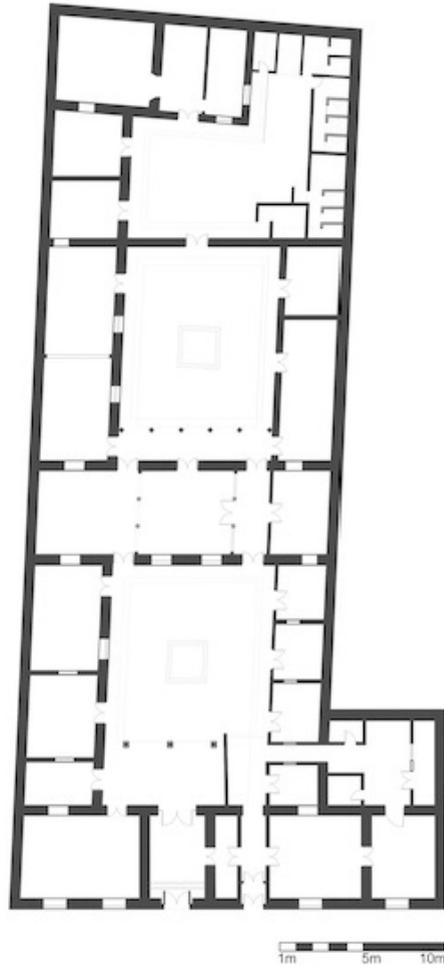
Planimetría de la Casa Santo Domingo. Elaboración propia.
